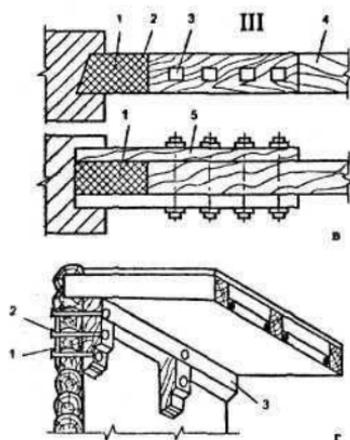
Ремонт деревянных перекрытий (продолжение):
